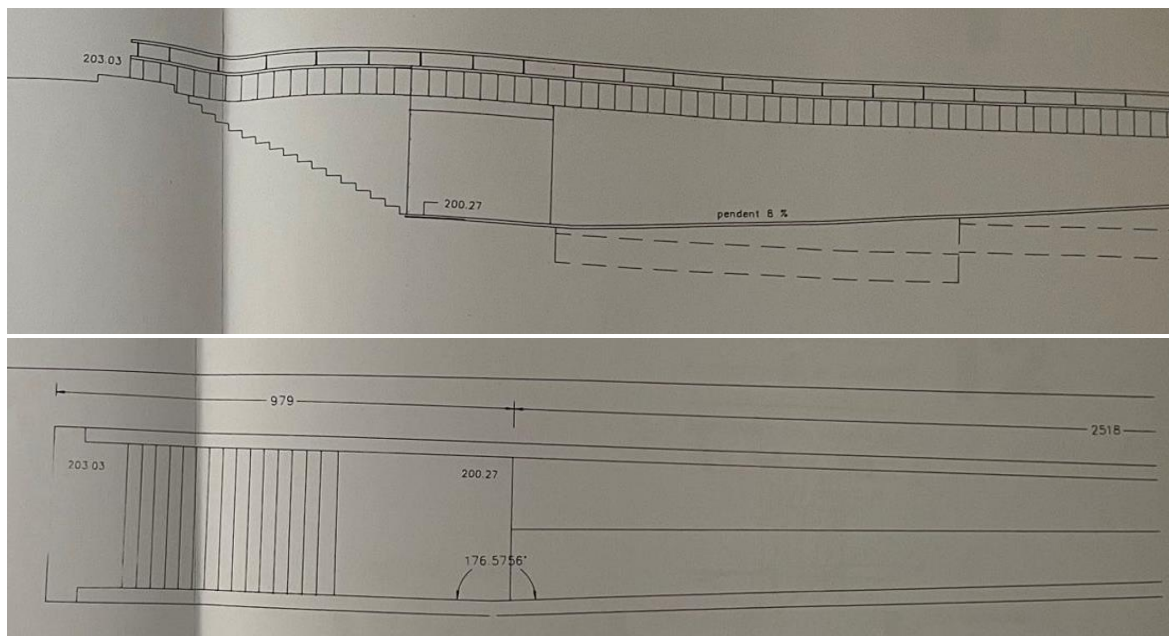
Secció longitudinal i planta projectada pel conjunt de rampes i escales d'accés al pas inferior.
